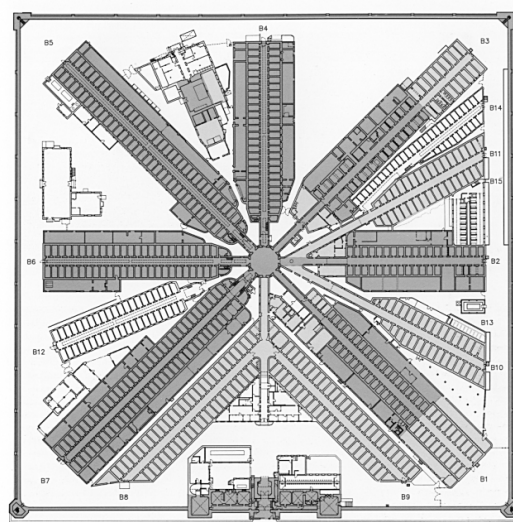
Planta de Eastern State Prison, na Filadélfia Pensilvânia, 1971
